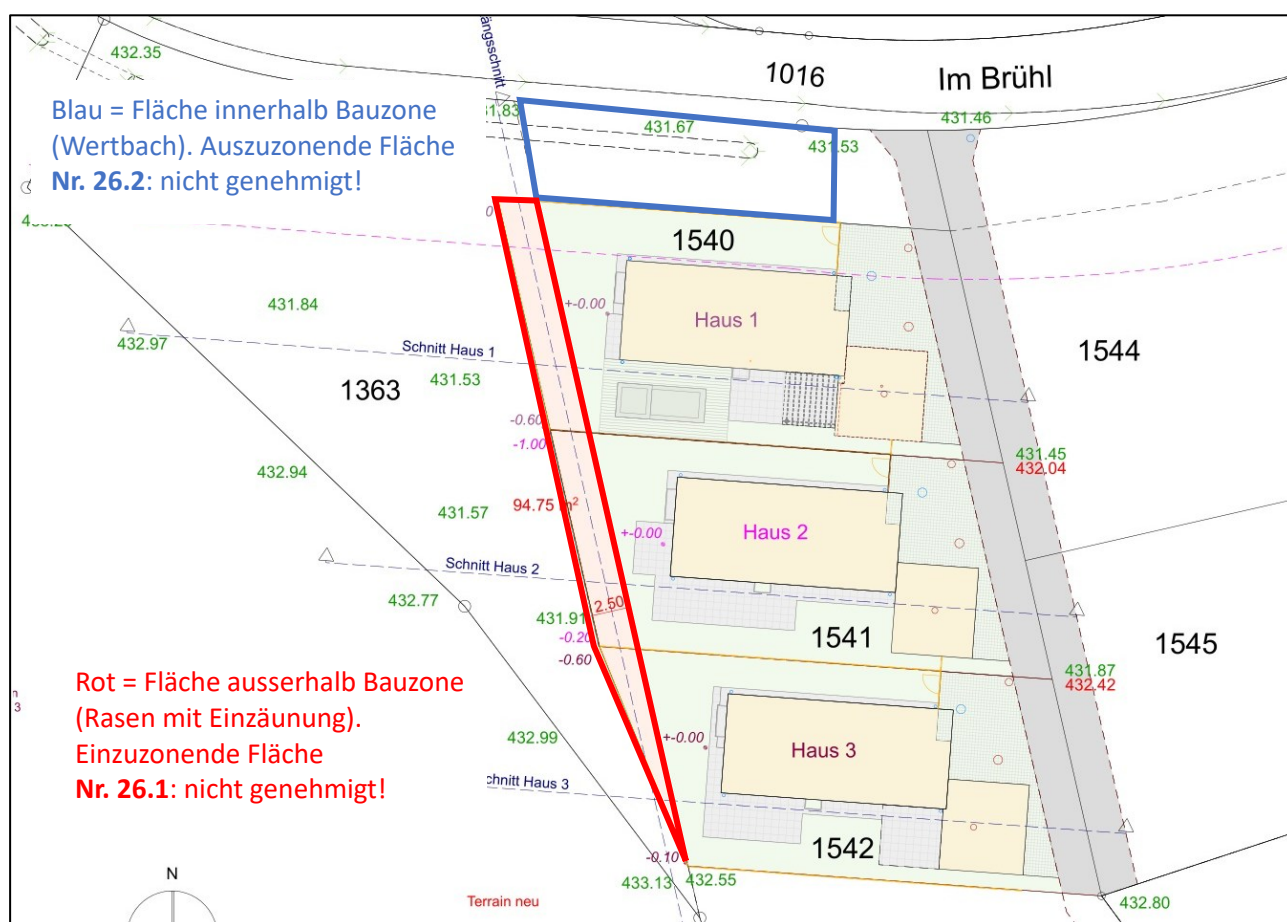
Übersichtsplan zur Zonenplanänderung «Im Brühl» aus dem Planungsbericht vom 02.11.2021.
